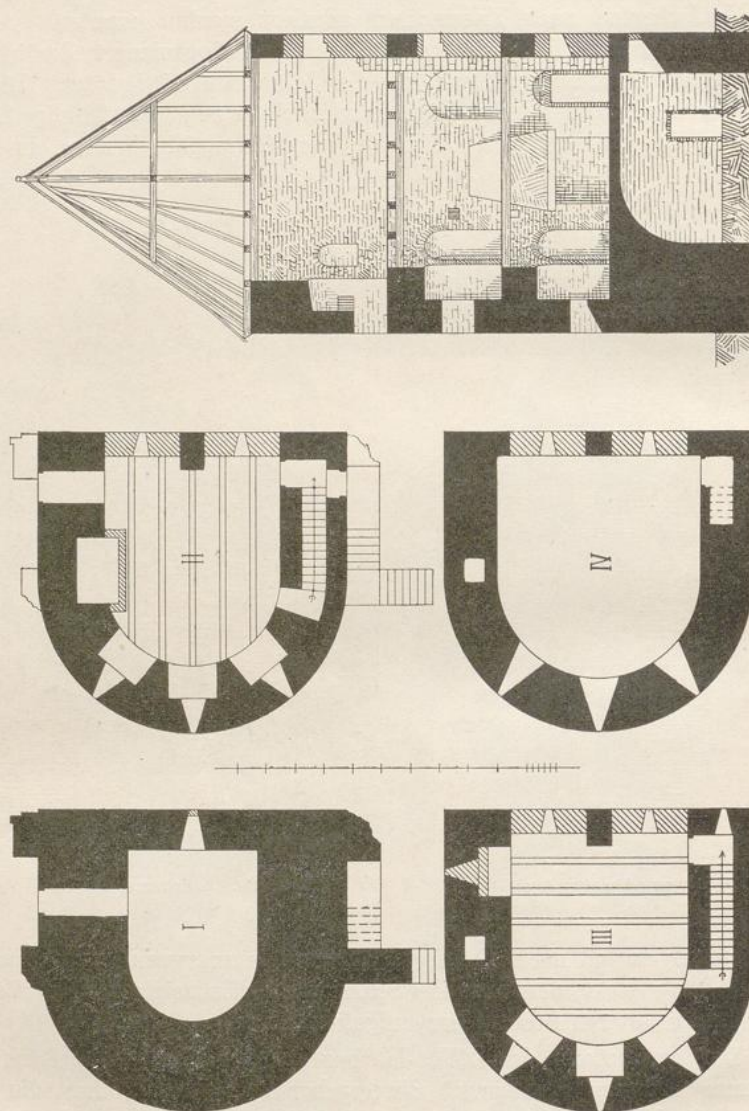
Bocksturm; Grundrisse und Schnitt.
